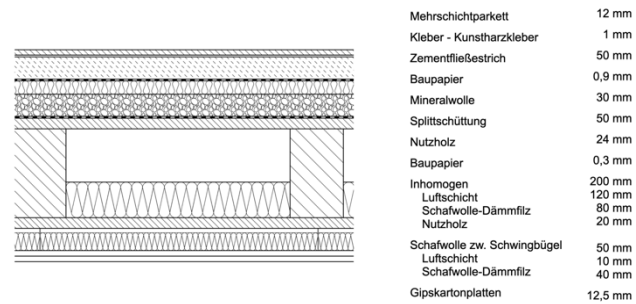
Detail Deckenaufbau Holzbalkendecke (maßstabslos)
